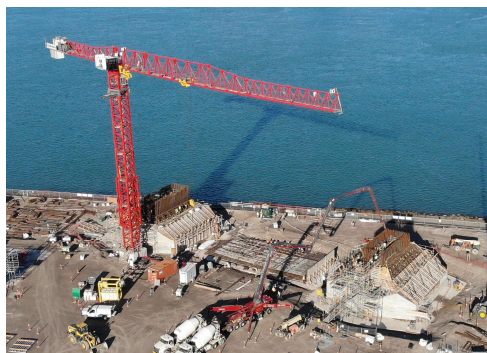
Vista del arranque de ambos fustes y la viga riostra de unión (torre de Canadá).
